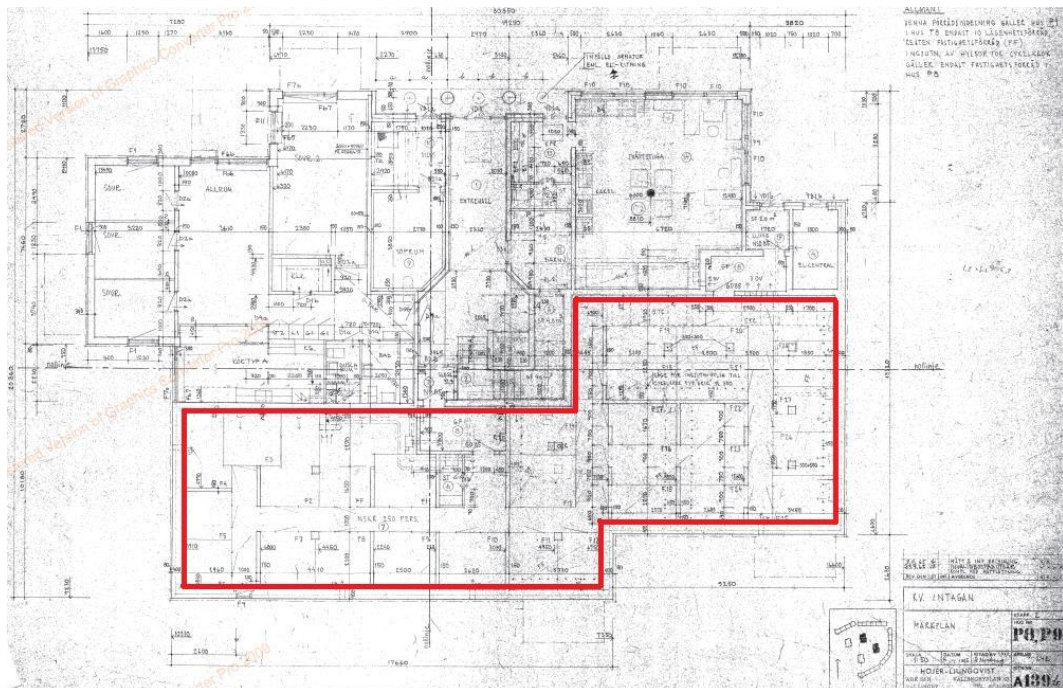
Volumen calefactado planta baja Glaciärvägen 21
